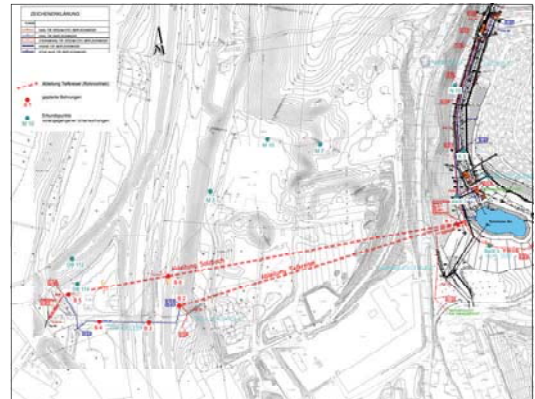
Lageplan mit Eintrag der Erkundungspunkte
